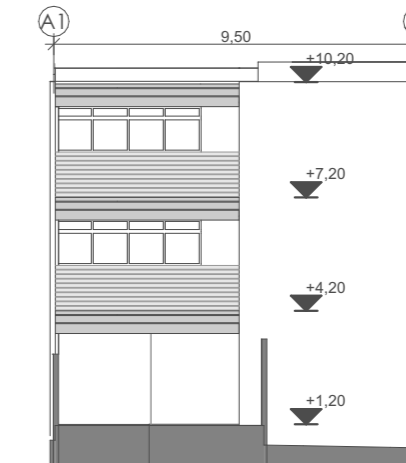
Alzado posterior del Bloque A (AP) Elaboración propia (2026). Escala 1:200
